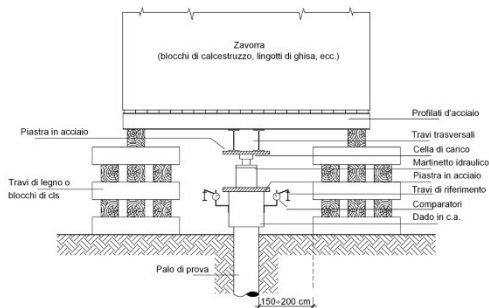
1 - Schema di applicazione del carico di prova su palo di fondazione con cassone zavorrato
